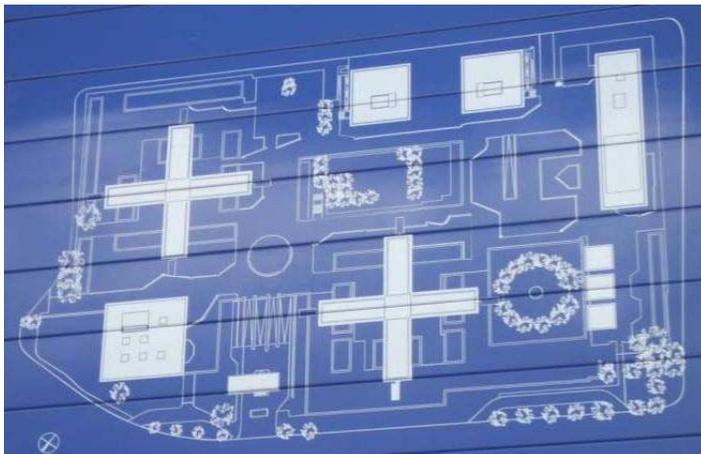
1: Lageplan der Kreuzbauten mit Nebengebäuden [Fotos (3): Grossmann][
